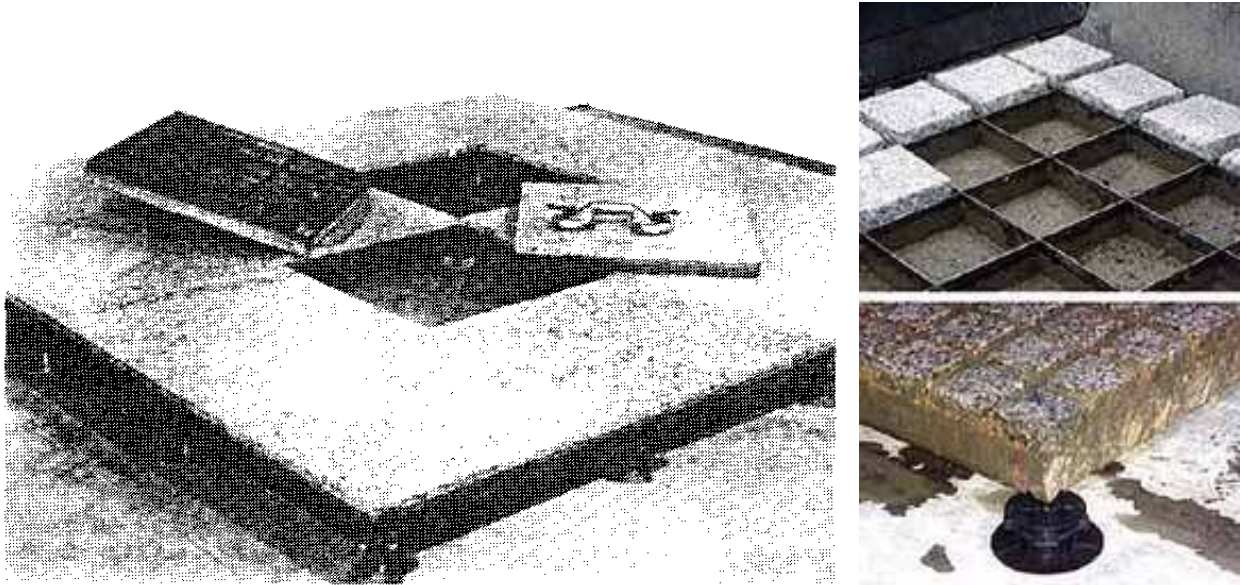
Pavimento flotante sobre estructura metálica.
